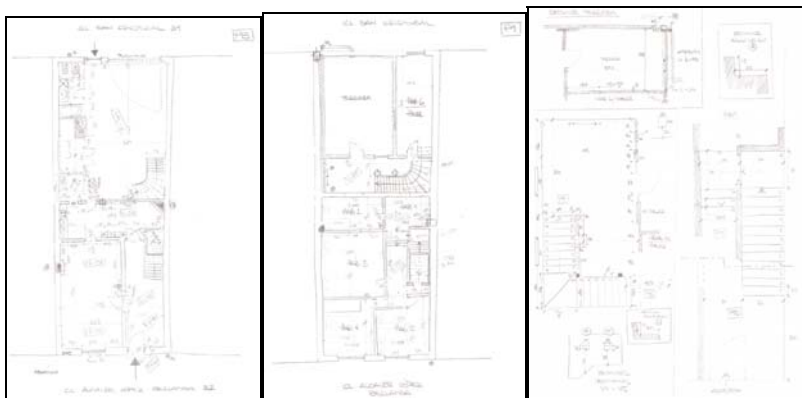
Croquis realizado por el alumno: planta baja, planta 1ª y detalles de escaleras y terraza. Fuente propia.
